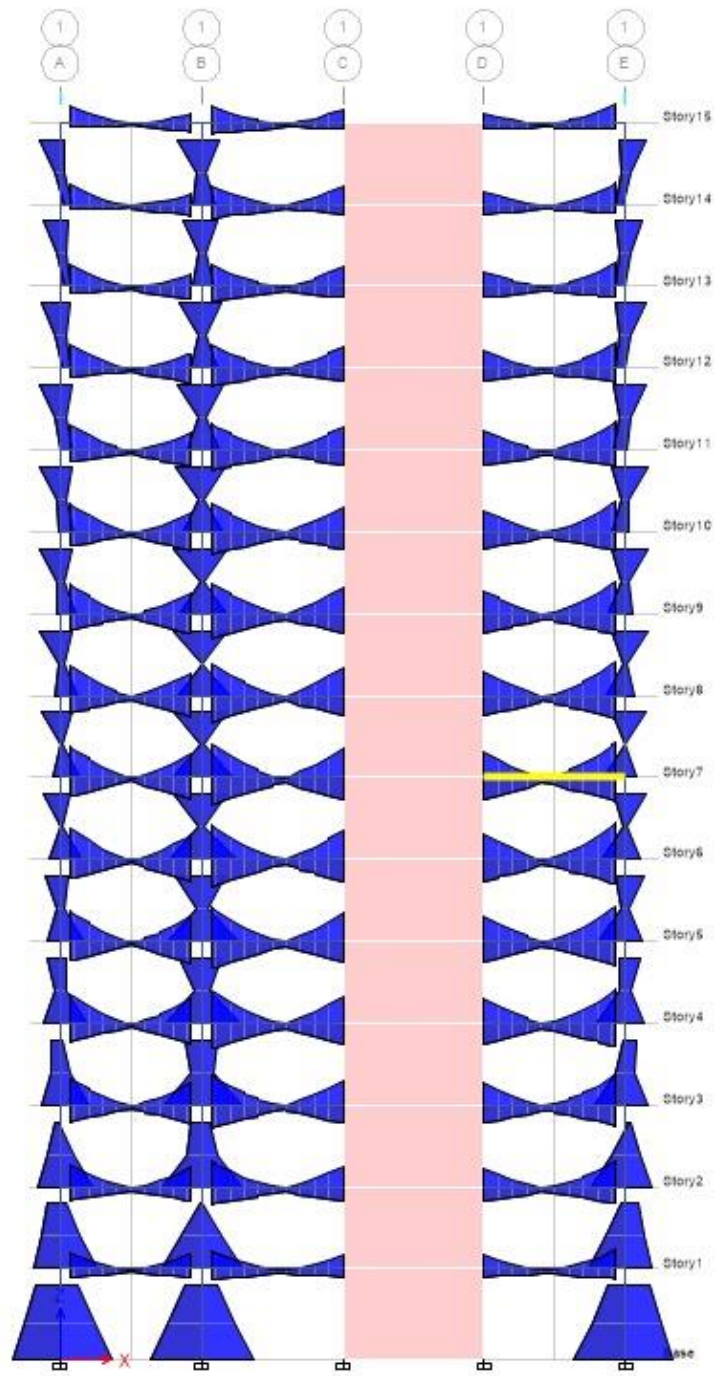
Elevación del pórtico donde se ubica la viga perimetral de V(0.25X0.50) a diseñar
